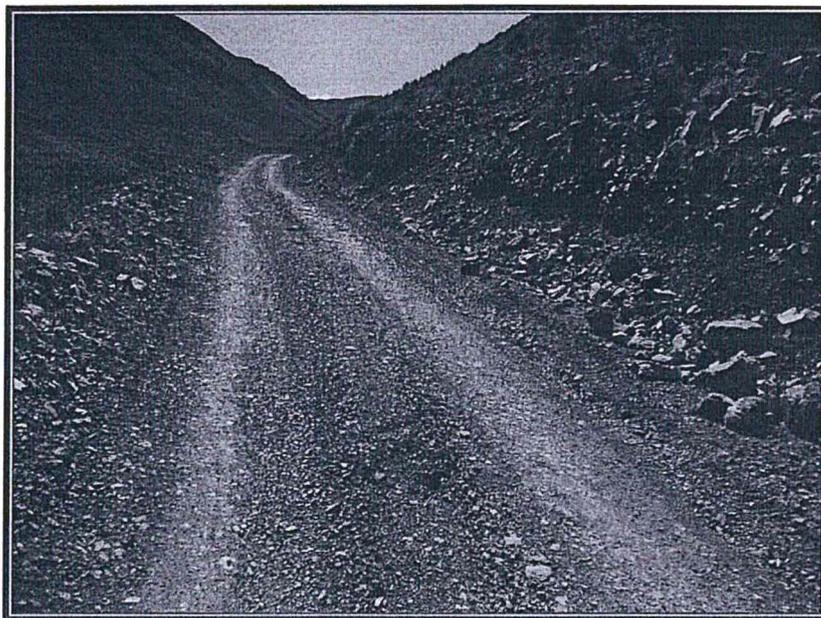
Hallazgo N° 5 Vista Fotográfica del sistema de contención (Barrera de sedimentación) de la vía de acceso en el sector Huacchara está colmatado.
